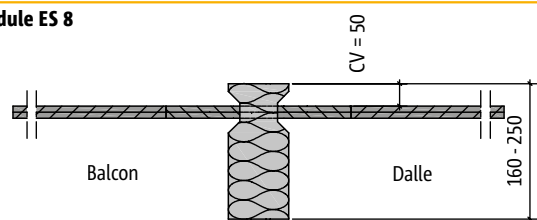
façade rapportée + isolation avec balcon en prolongement de dalle + modèle K + module ES
